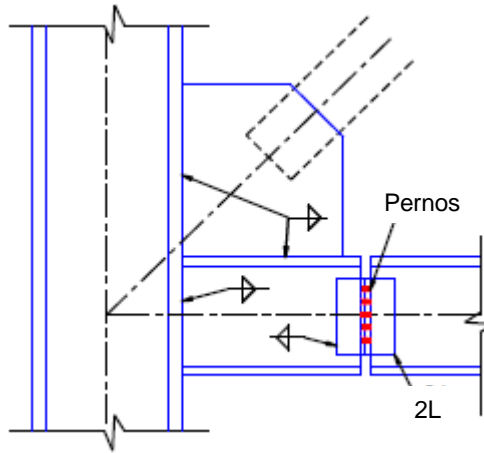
Detalle de la conexión viga-columna recomendada [Thornton & Muir 2008]<sup>[4]</sup>
